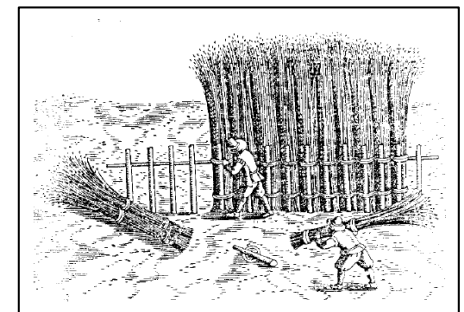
Construcción con un bastidor de madera, también llamado blinda, y, en este caso, con fajinas que dan protección. Ufano 1613
